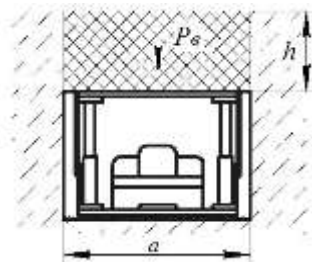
Расчетная схема для определения усилия передвигки шагающей крепи проходческого комплекса при вертикальной нагрузке (P_v), действующей на перекрытия крепи со стороны кровли выработки
